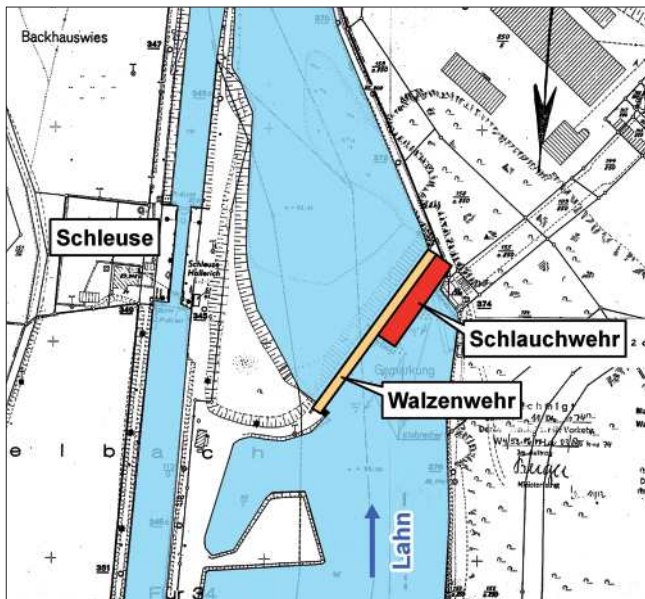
Lageplan der Lahnstaustufe Hollerich mit dem Schlauchwehr [8]
